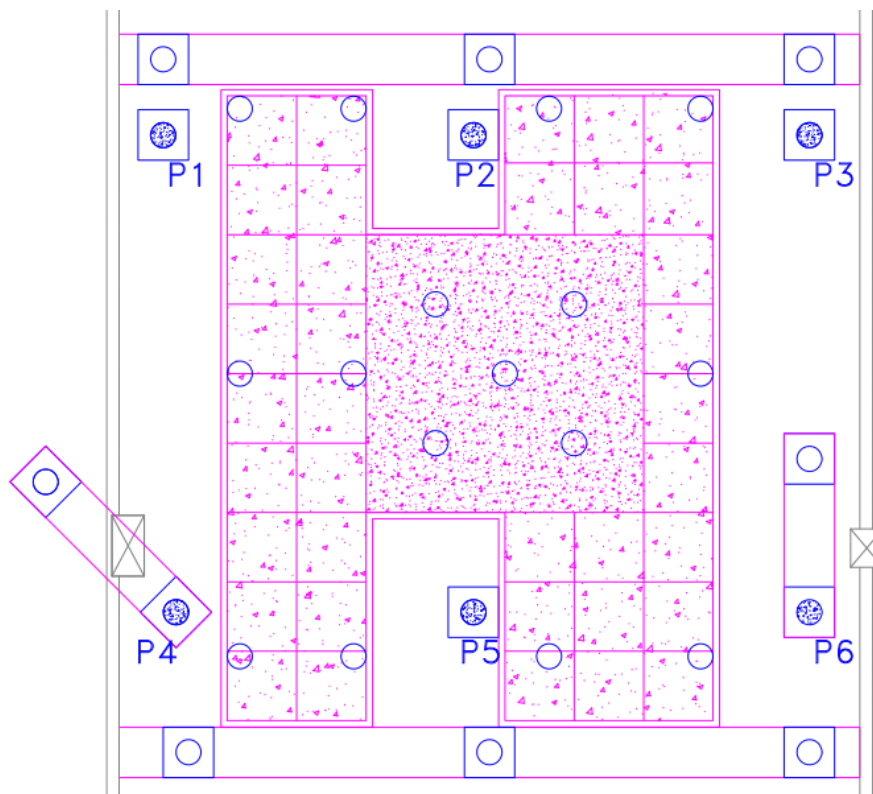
Plan du massif et positionnement des pieux (cf. plan BIM 18/12/2024)
